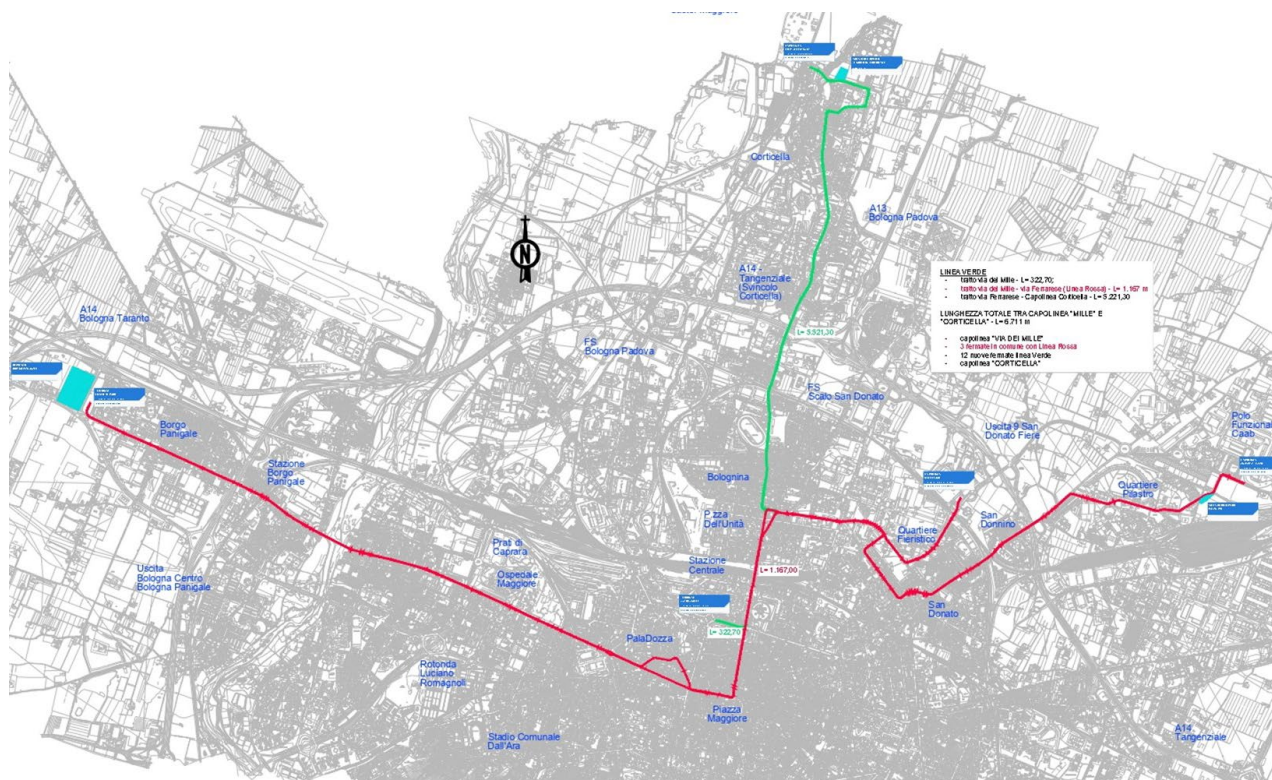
Planimetria generale Linea 1+Diramazione nord per Corticella
